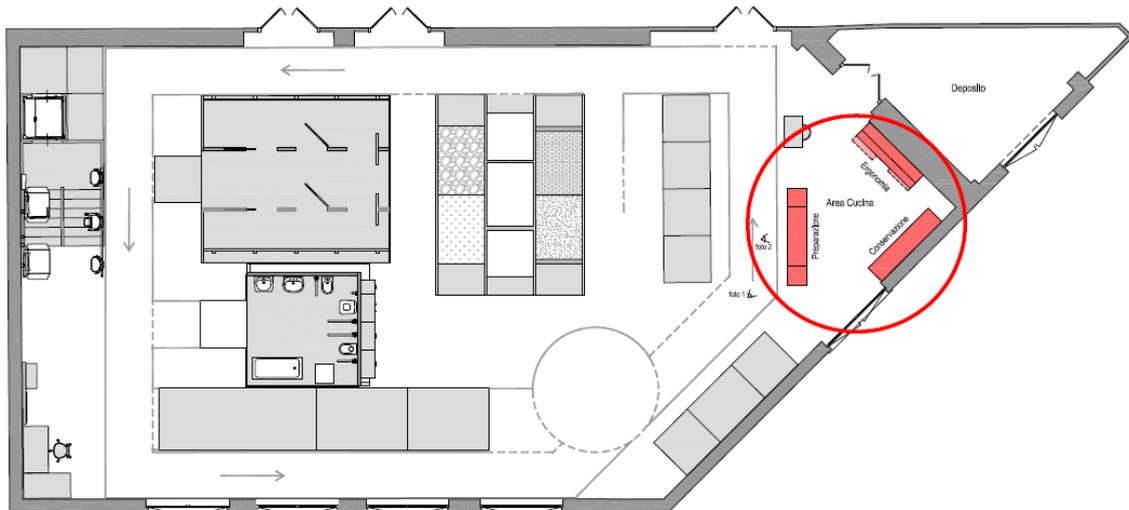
Planimetria Palestra di AUSILIA- Area Cucina
